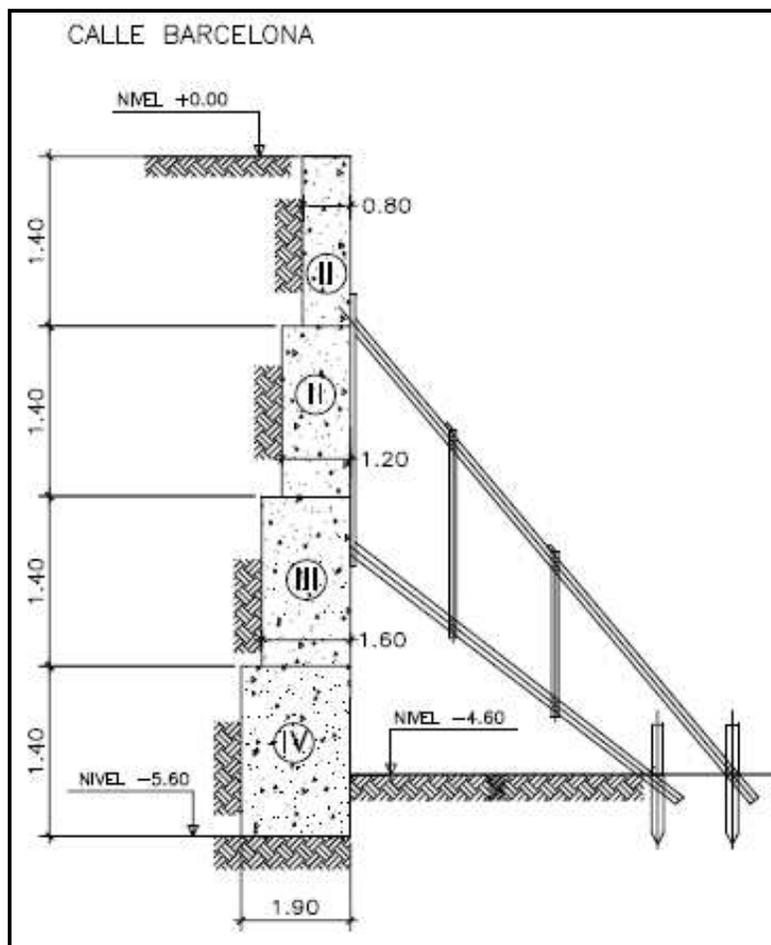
Corte típico de calzadura obra 1 – Edificio Barcelona.
